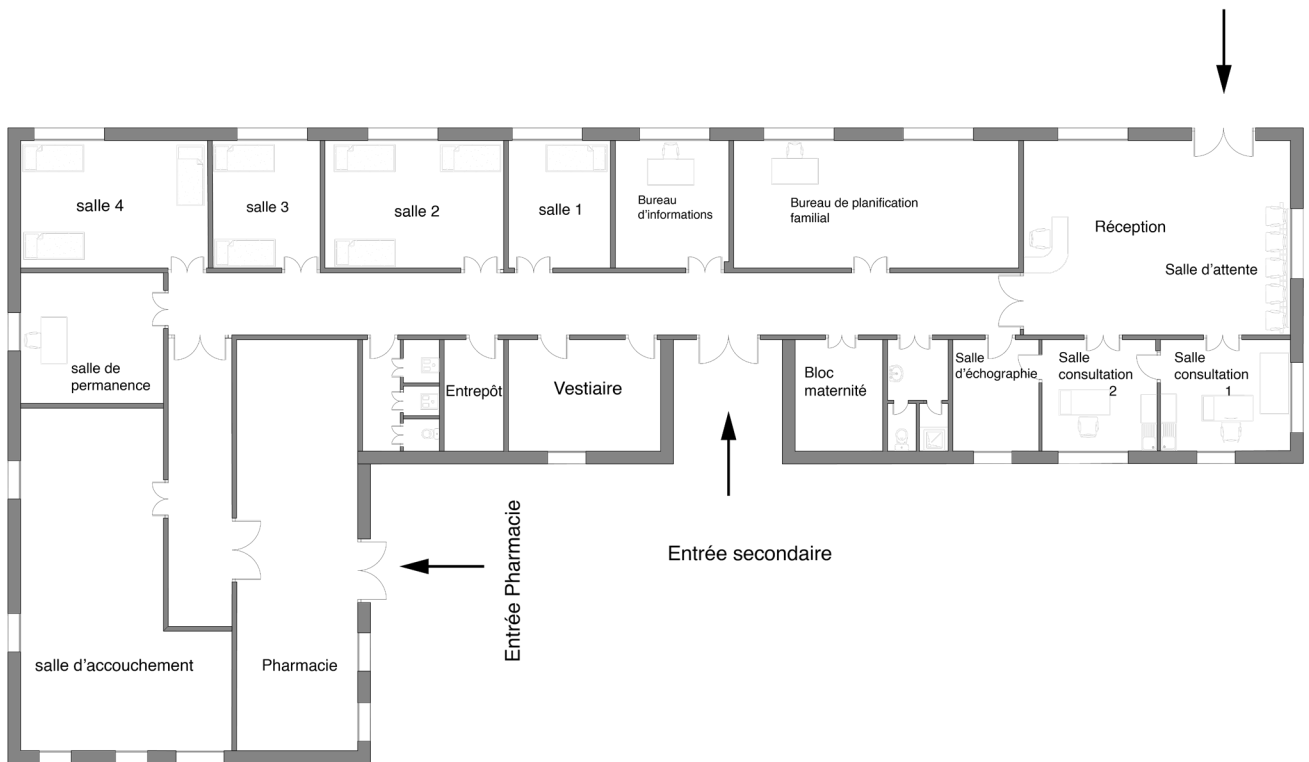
Plan du rez-de-chaussée du dispensaire
